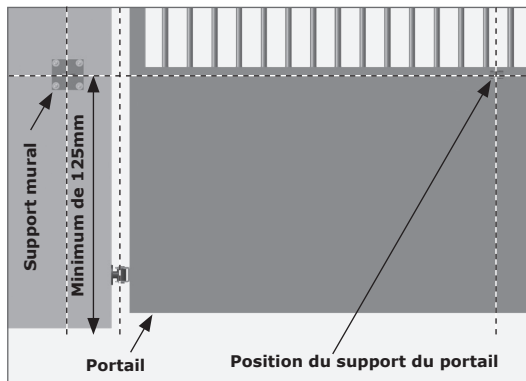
HAUTEUR DU SUPPORT MURAL
